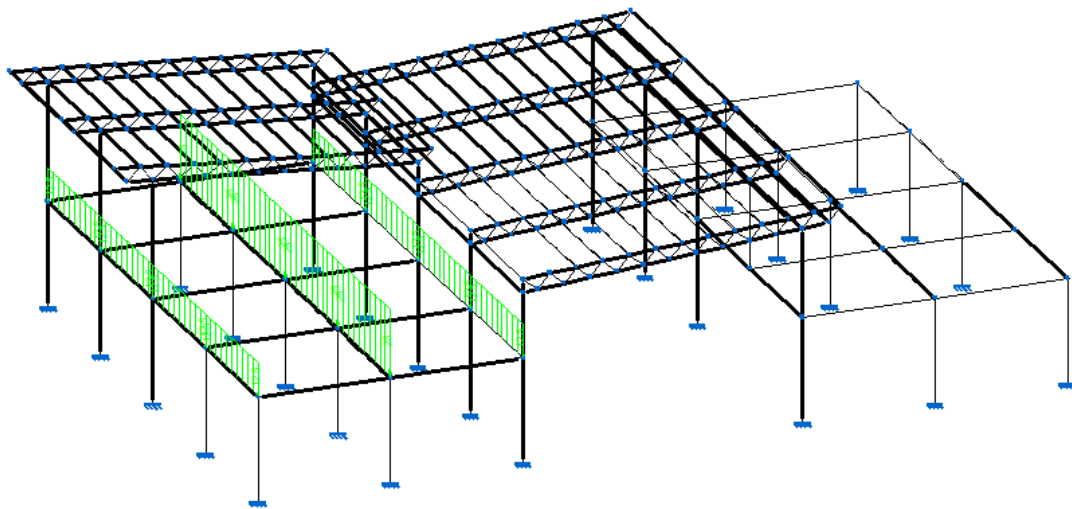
Sobrecargas en estructura metálica. Fuente: Elaboración propia
